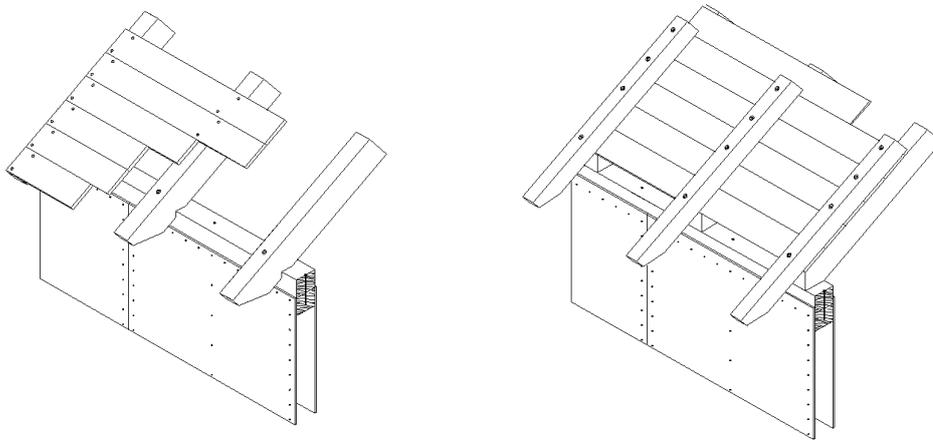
Copertura a travetti di un edificio intelaiato: soluzione con travetti continui in appoggio sulle pareti esterne oppure soluzione con "falsi travetti" in gronda
